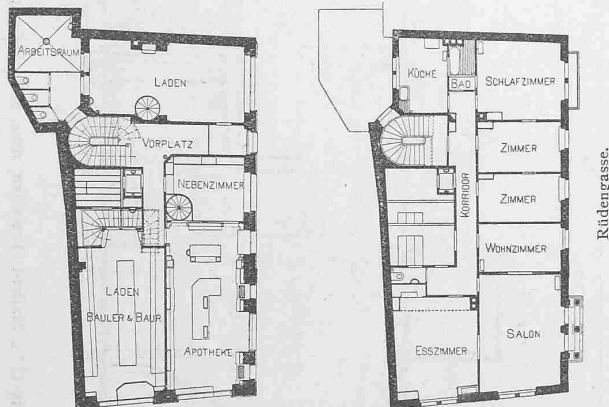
Die «Goldene Apotheke». Grundrisse vom Erdgeschoss und vom III. Stock. — Masstab 1:400.
